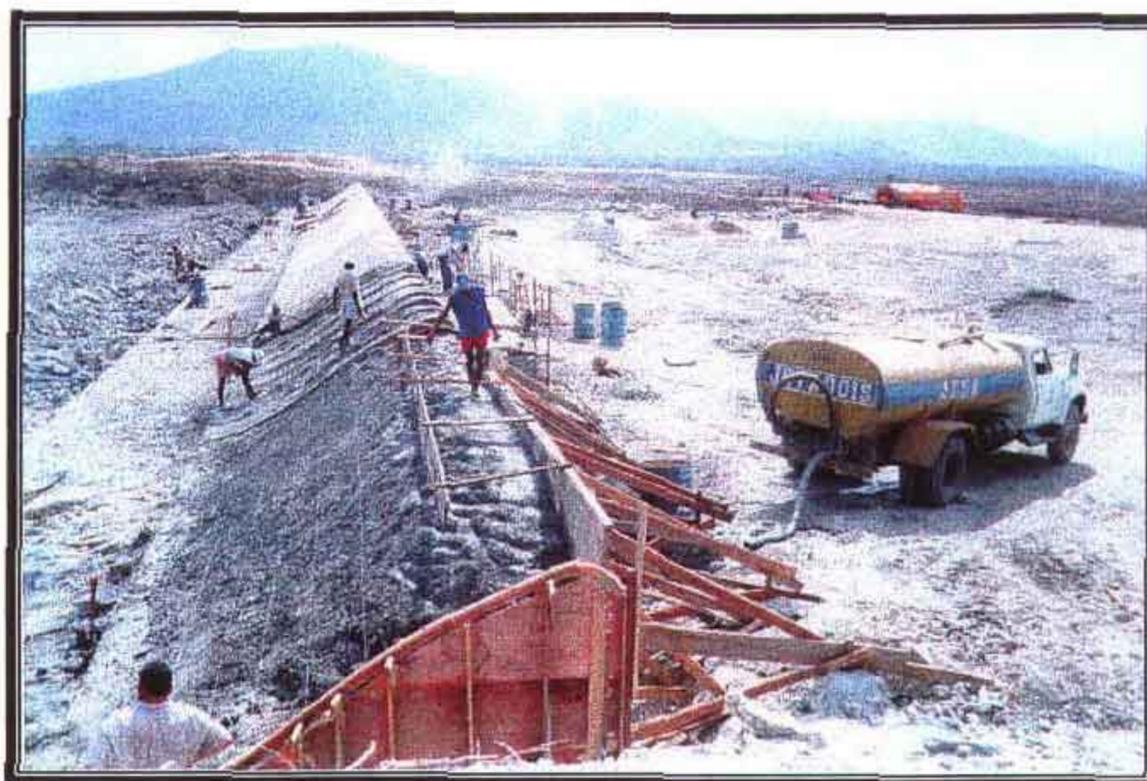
Fase construção do creager, vista da estaca E-9
